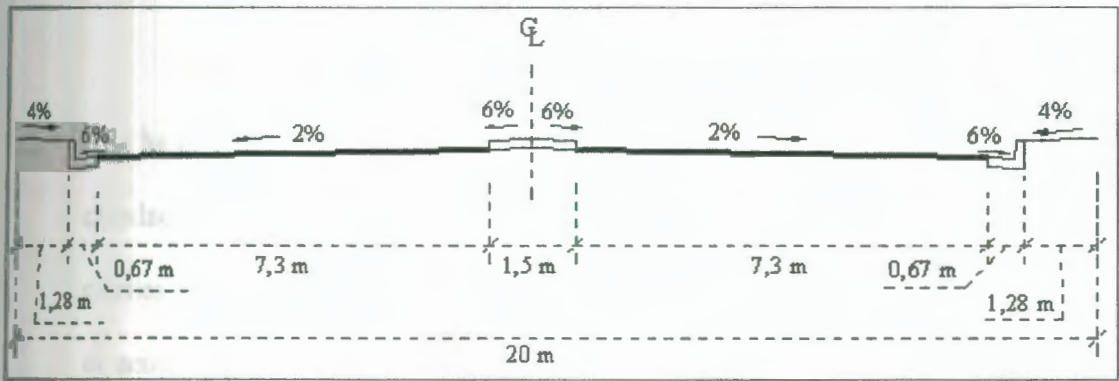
ALTERNATIVA DE SECCIÓN TIPO # 1
